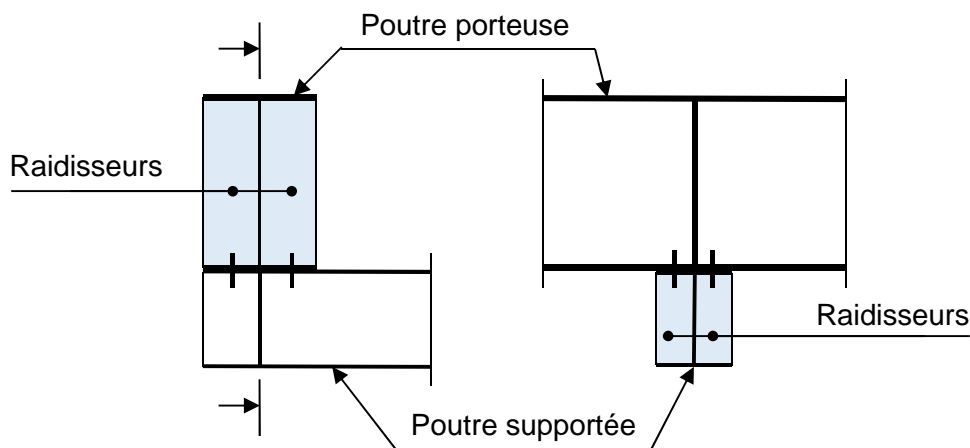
Raidisseurs à prévoir au droit des appuis des poutres suspendues
